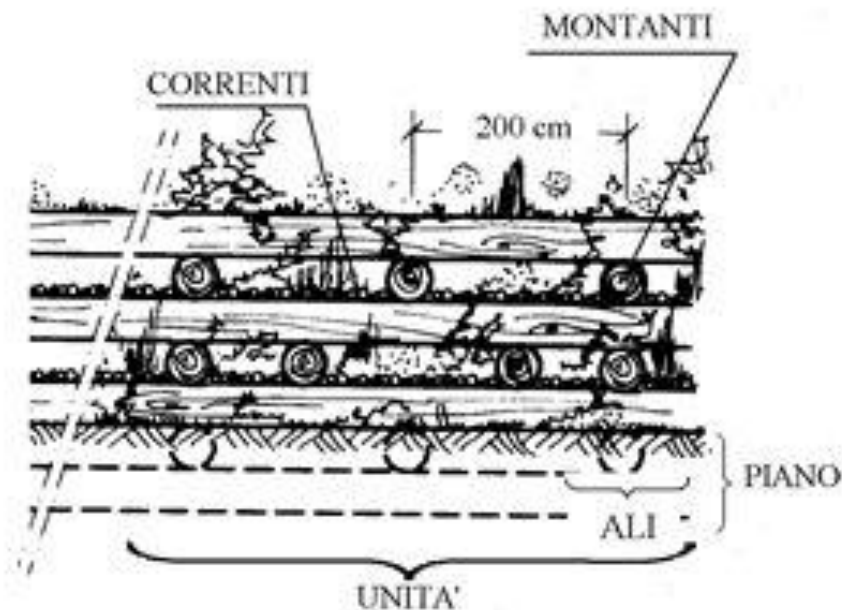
Palificata viva di sostegno a parete doppia - vista elementi.
